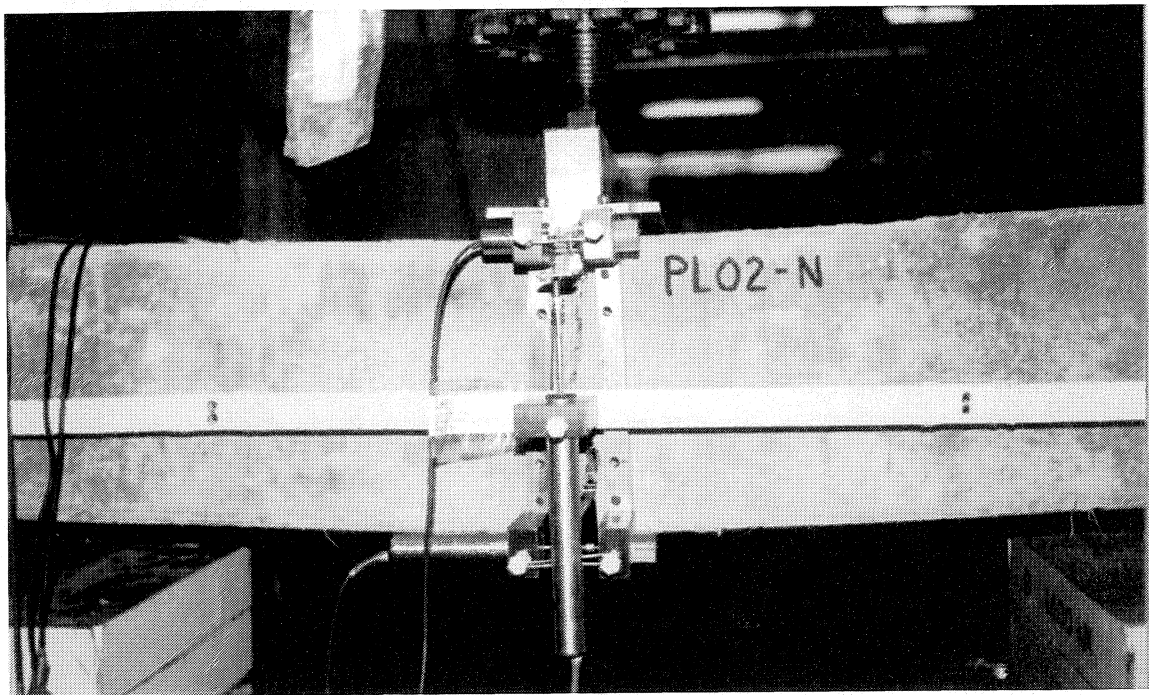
Instrumentation de la section centrale d'une poutre DBM
